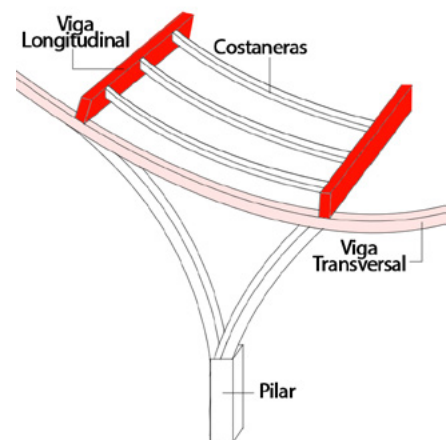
Esquema Sistema Estructural Cubierta. Pilar y Viga.
